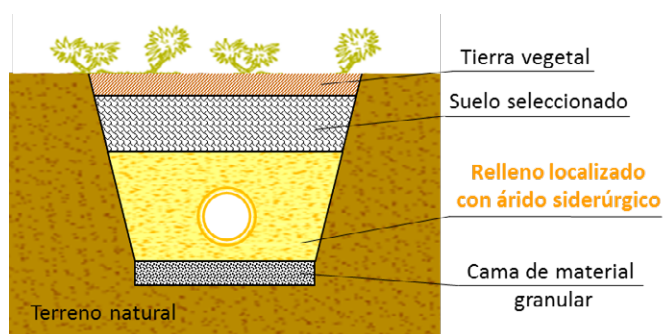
CUBRICIÓN DE TUBERÍAS BAJO COBERTURA DE IMPERMEABILIZACIÓN PARCIAL.
